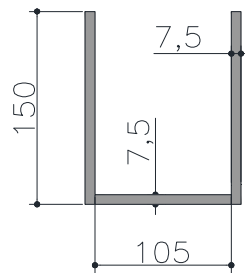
Dimensões do perfil metálico utilizado como consolo metálico.
